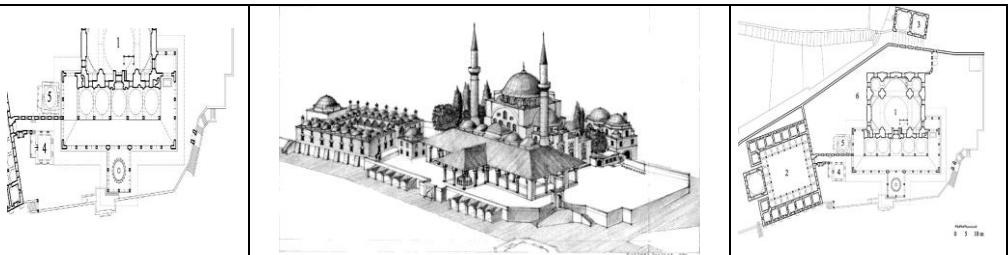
مسقّط أفقى وقطع لمسجد محمود باشا بإسطنبول يوضح سقيفته.
